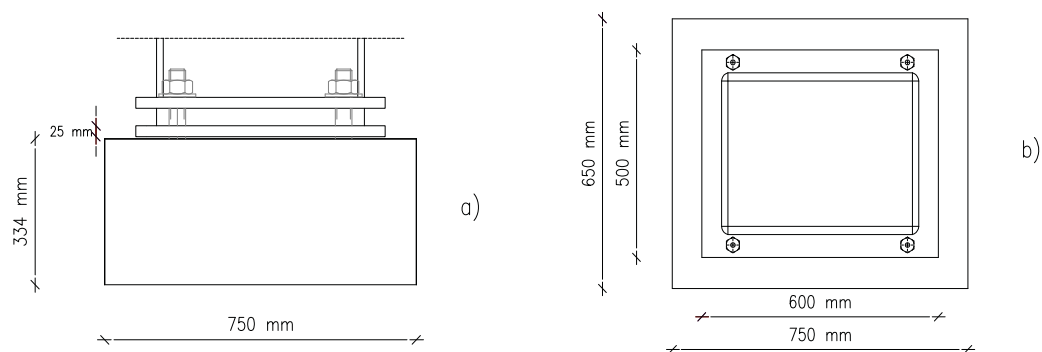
a) Vista em alçado do aparelho de apoio do primeiro tramo da ponte. b) Vista em planta do apoio do primeiro tramo da ponte.
